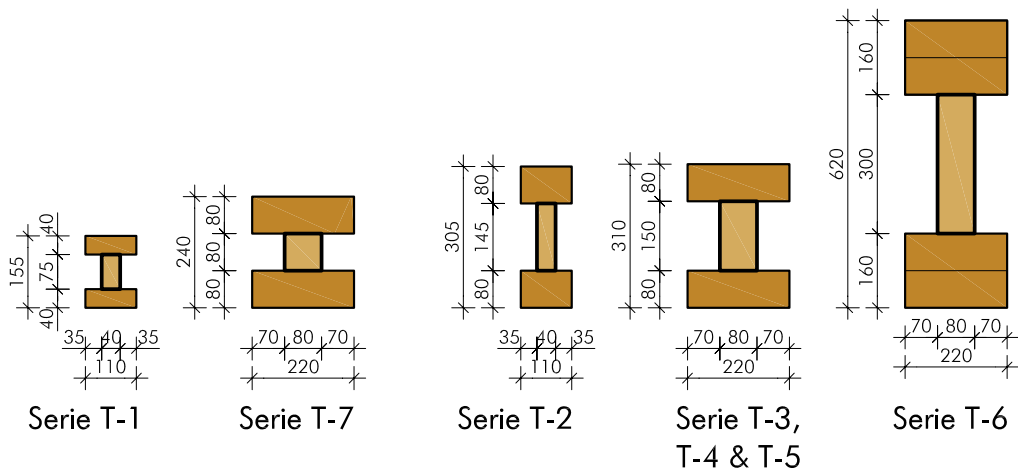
Querschnitte mit den Abmessungen der untersuchten Prüfräger
